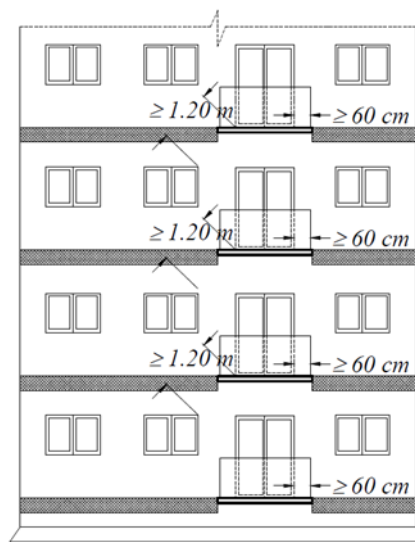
Решение по ограничению распространения пожара по фасаду в местах пересечения с балконами
